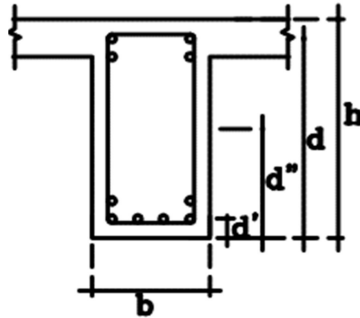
21 Rencana Denah Pembalokan (Balok Induk B1)
